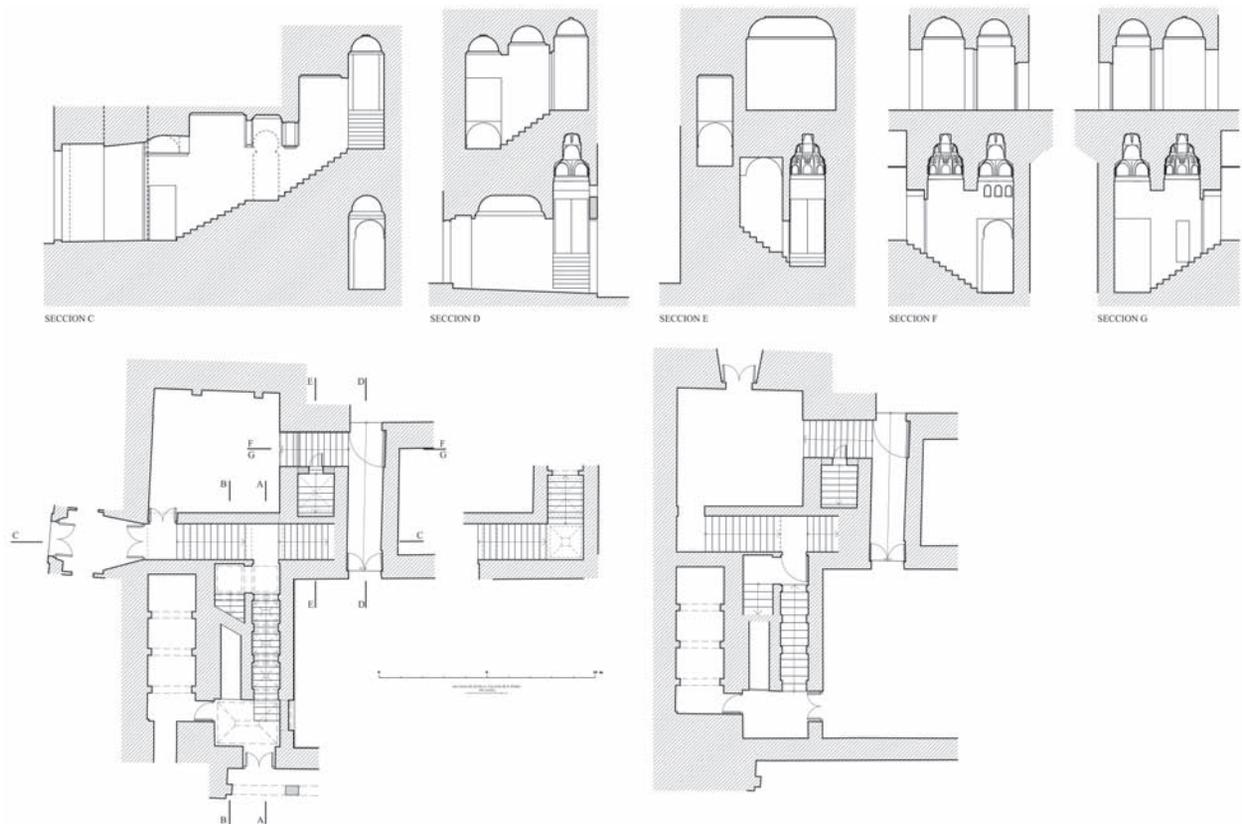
Plantas y secciones de la escalera privada. La planta de la derecha corresponde al estado original. En ambas plantas aparecen representadas las dos escaleras, pública y privada (A. Almagro).
